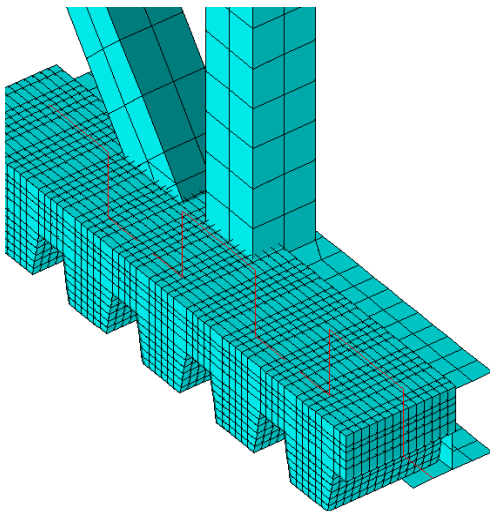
Фрагмент опирания плиты перекрытия на пояс фермы
